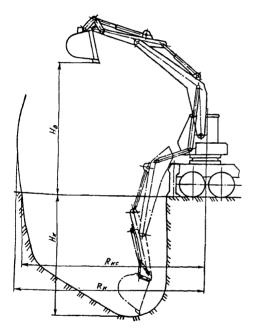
Рабочие размеры экскаватора ЭО-4421A с оборудованием обратной лопаты
